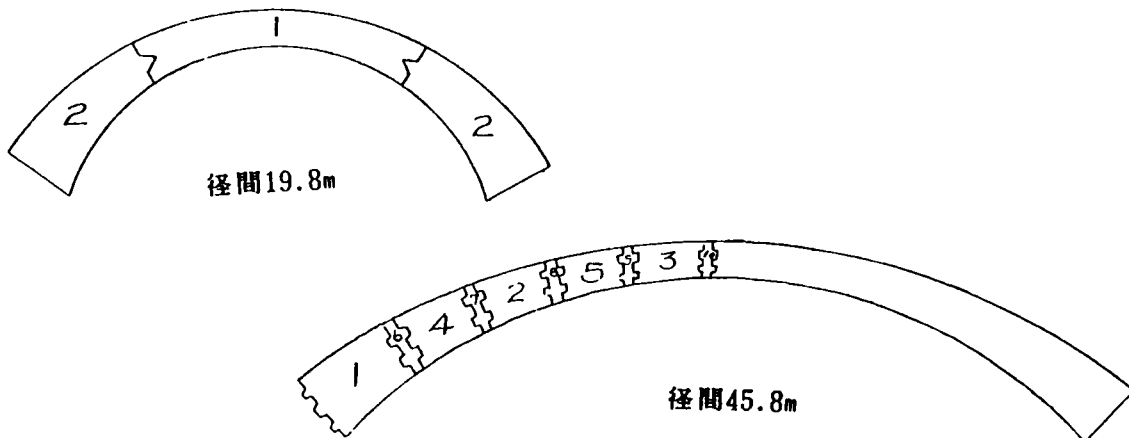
鉄筋コンクリートアーチ橋の施工継目と打設順序<sup>19)</sup>
